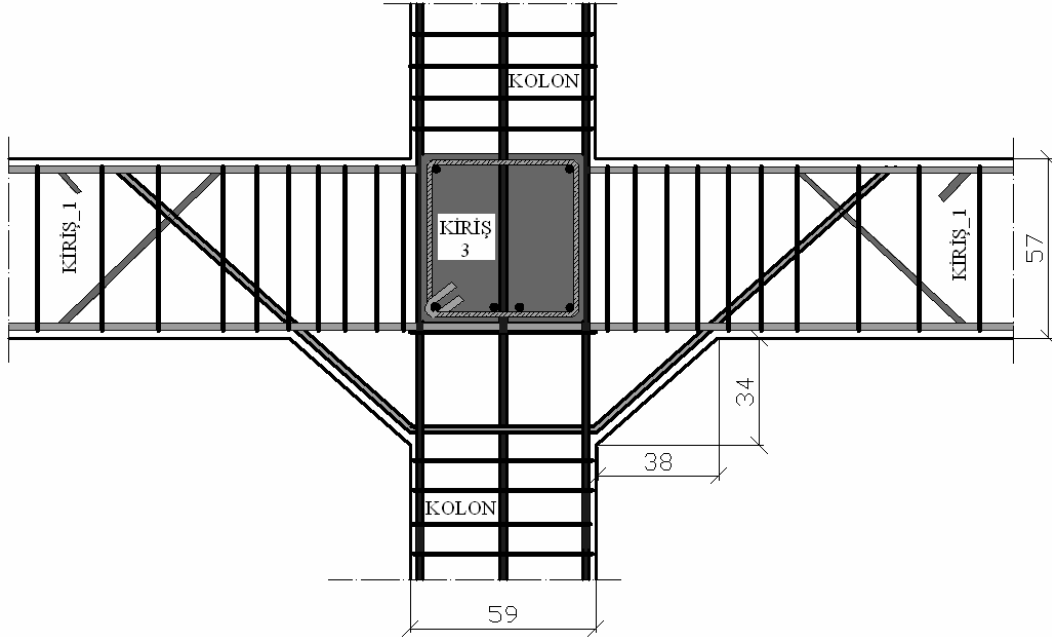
Çift yöndeki kiriş ve kolon birleşim donatı çizimi (sol yan görünüş)
